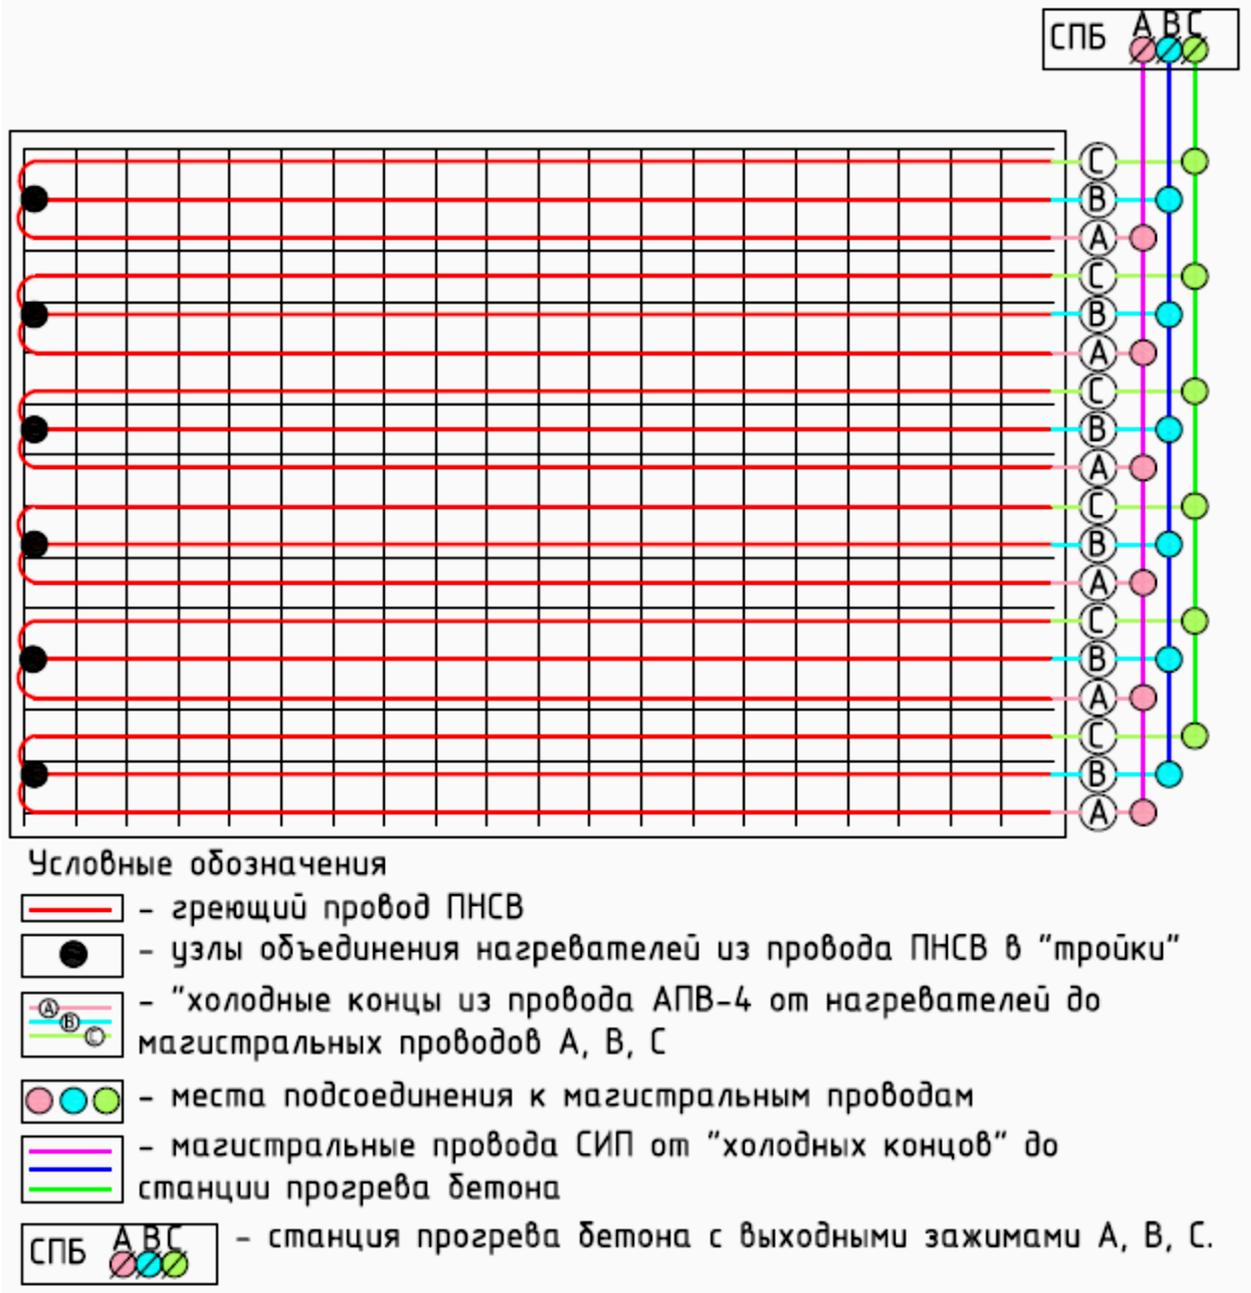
Монтаж провода для прогрева перекрытия при подключении по схеме «звезда»
